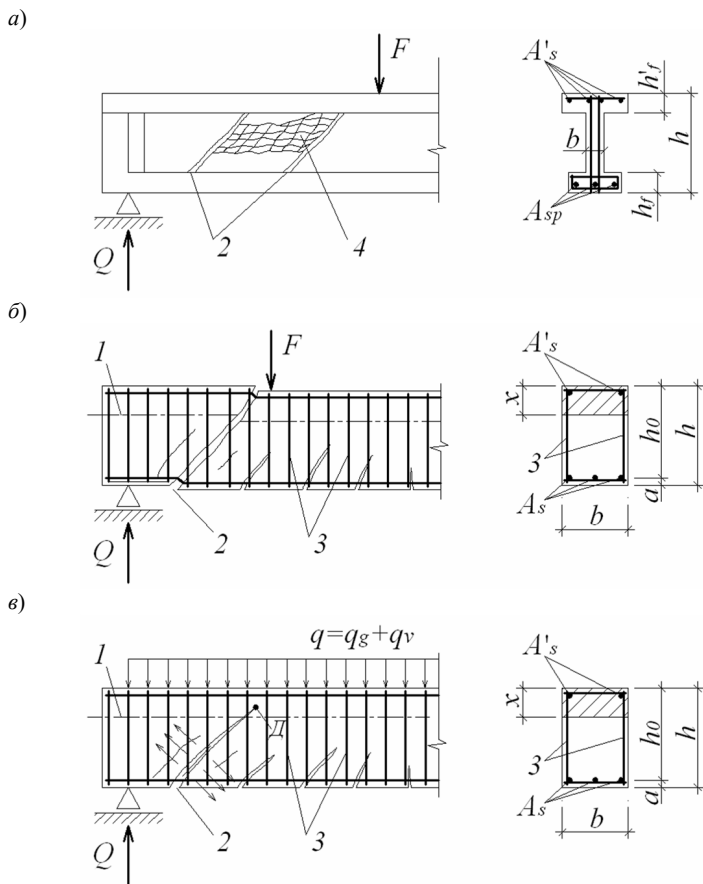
Схема разрушения изгибаемых элементов по наклонному сечению: a – по сжатой полосе между наклонными трещинами; b – то же, поперечной силы; ϑ – от доминирующего действия изгибающего момента; 1 – нулевая линия; 2 – наклонная трещина; 3 – хомуты (поперечные стержни); 4 – раздробление сжатой полосы стенки
